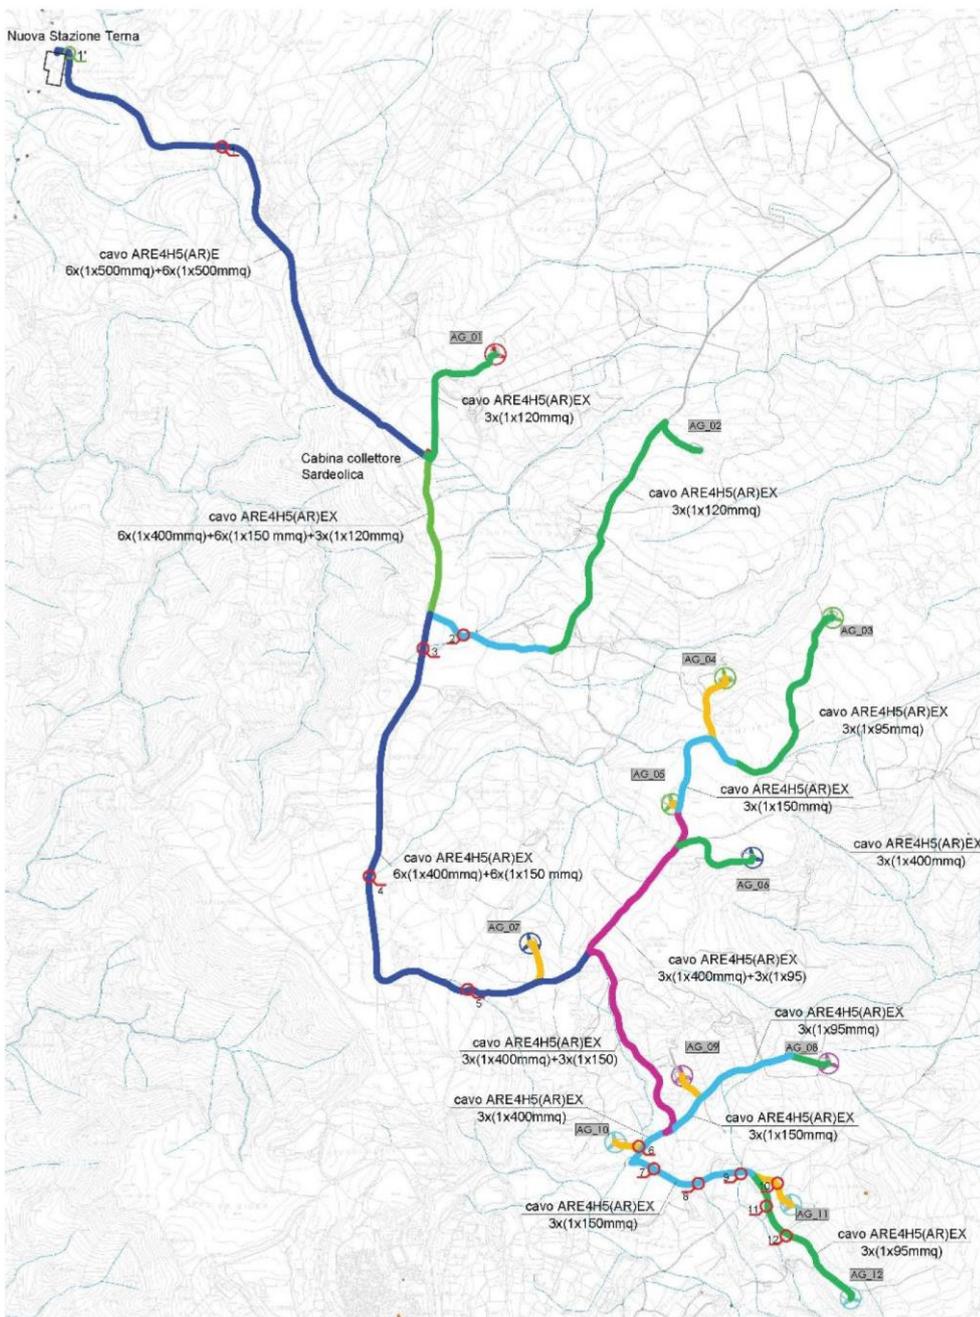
Planimetria del cavidotto su CTR con attraversamenti (in rosso).
